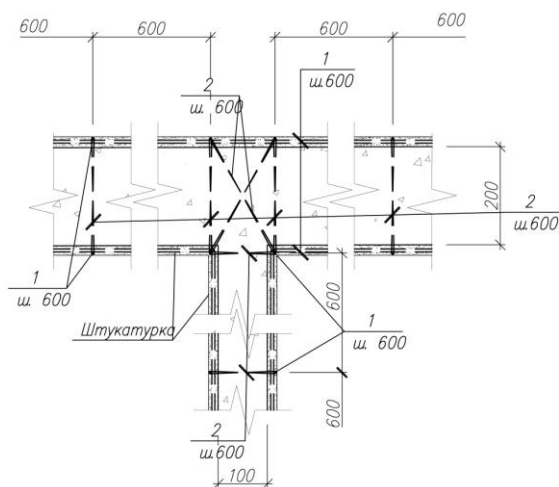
Сопряжение перегородок из керамзитобетонных блоков разной толщиной
